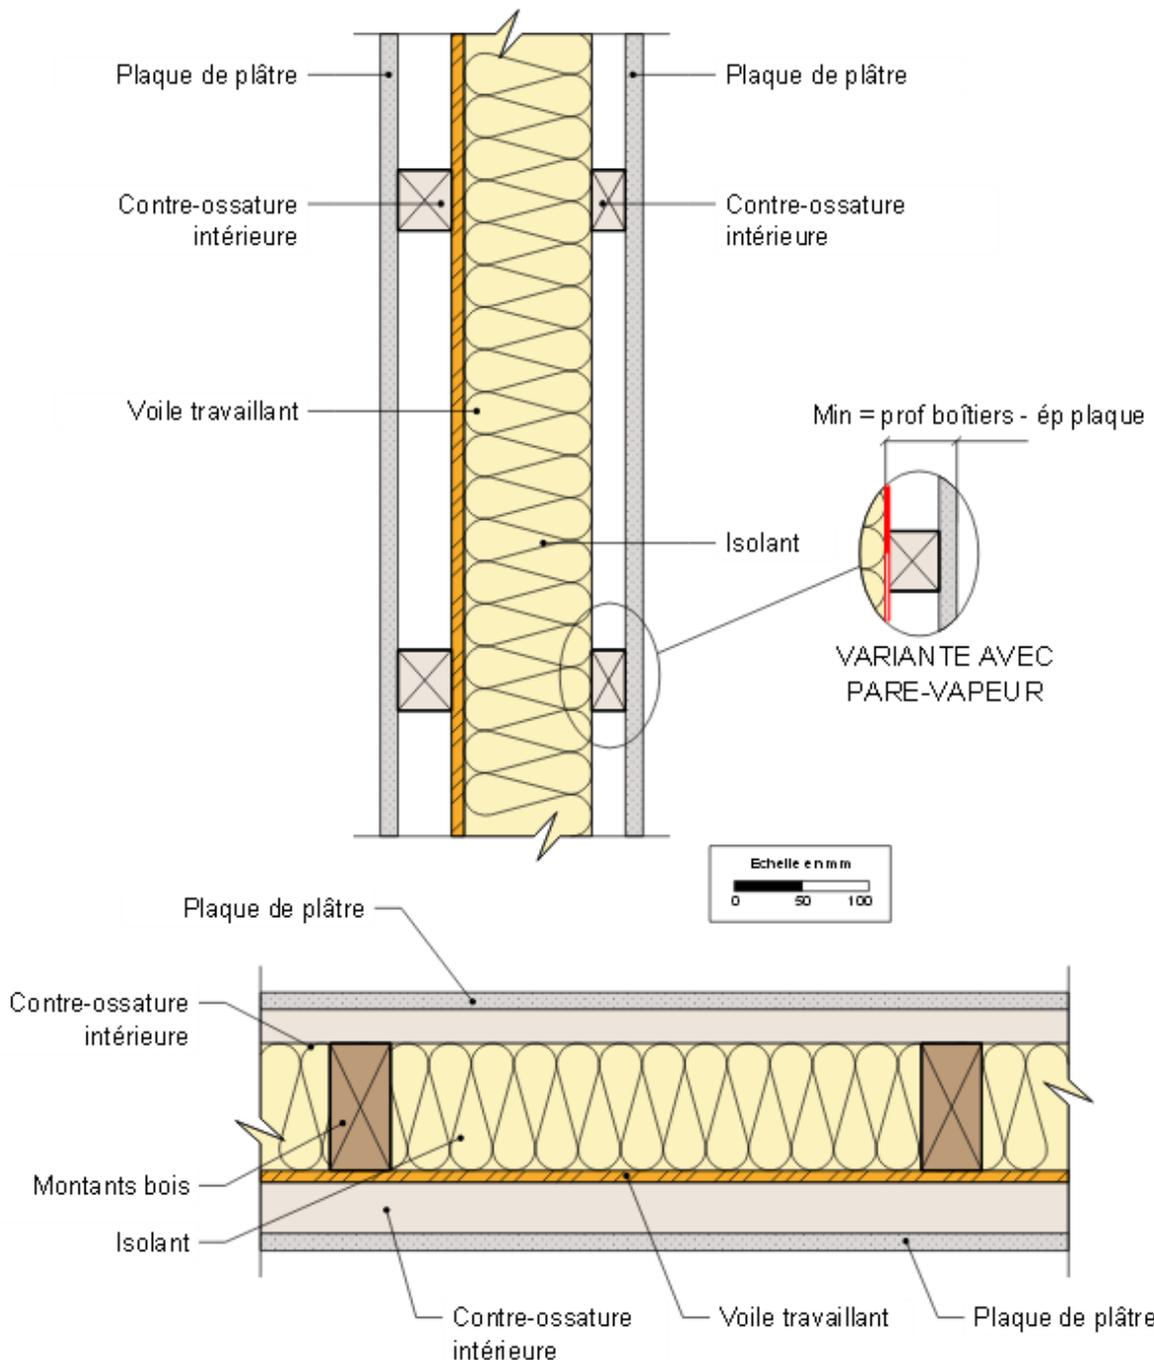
Contreventement sur une face et tasseautage support de parement sur deux faces (coupe verticale en haut, verticale en bas)
